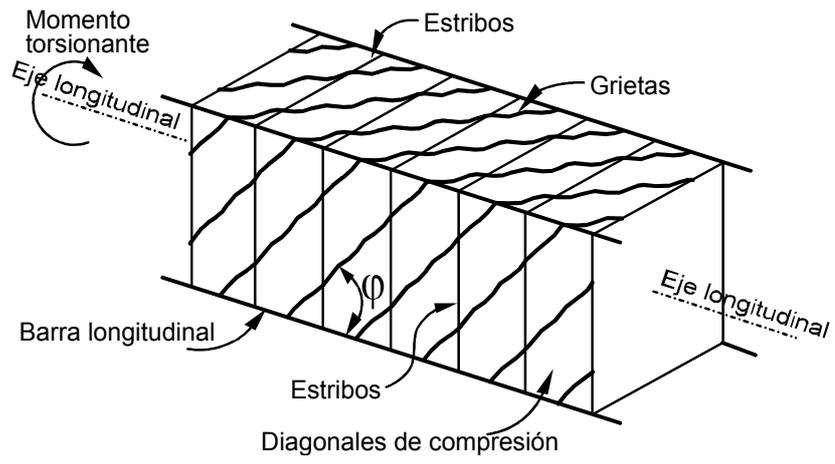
Analogía de la armadura reforzada para torsión.
